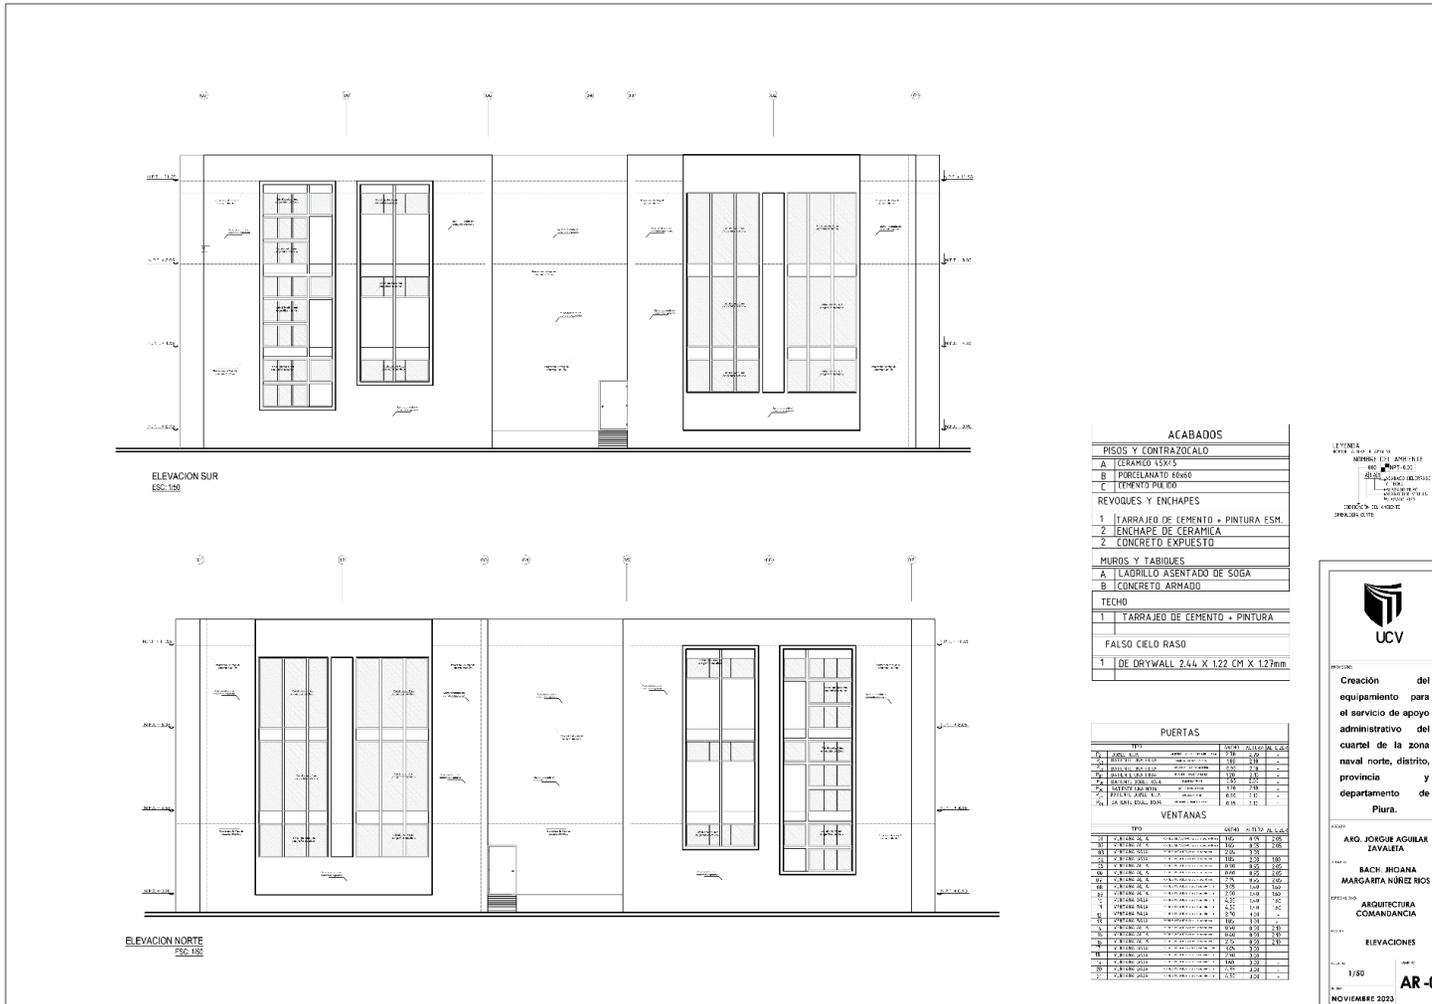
Planos de desarrollo: Bloque Comandancia – Elevación Sur y Norte
